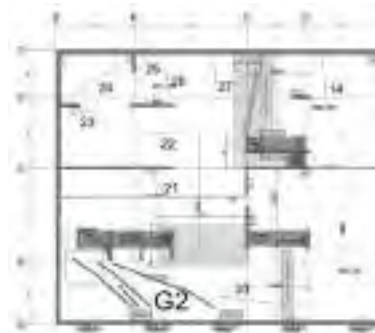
Grupo de fisuras G2 (3)
